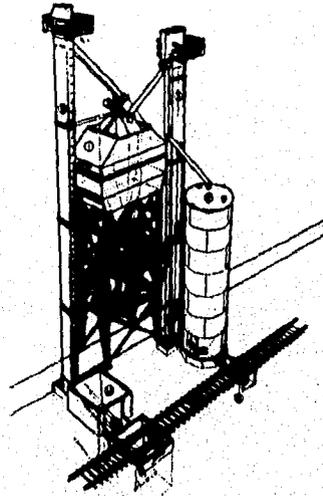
Planta estacionaria mezcladora de concreto.
